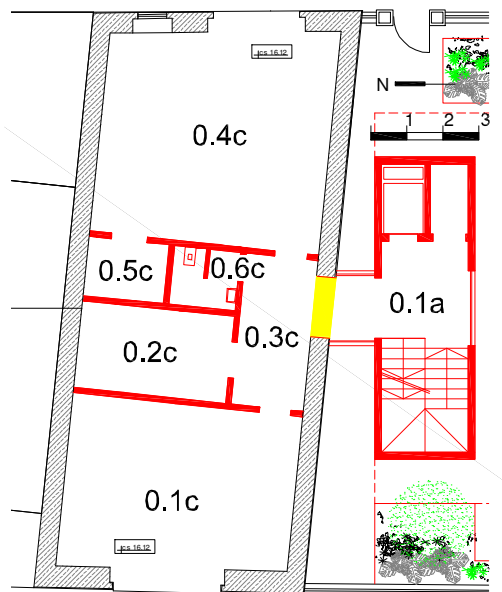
Cocheiras: Planta do Piso Térreo com as Cores Convencionais
